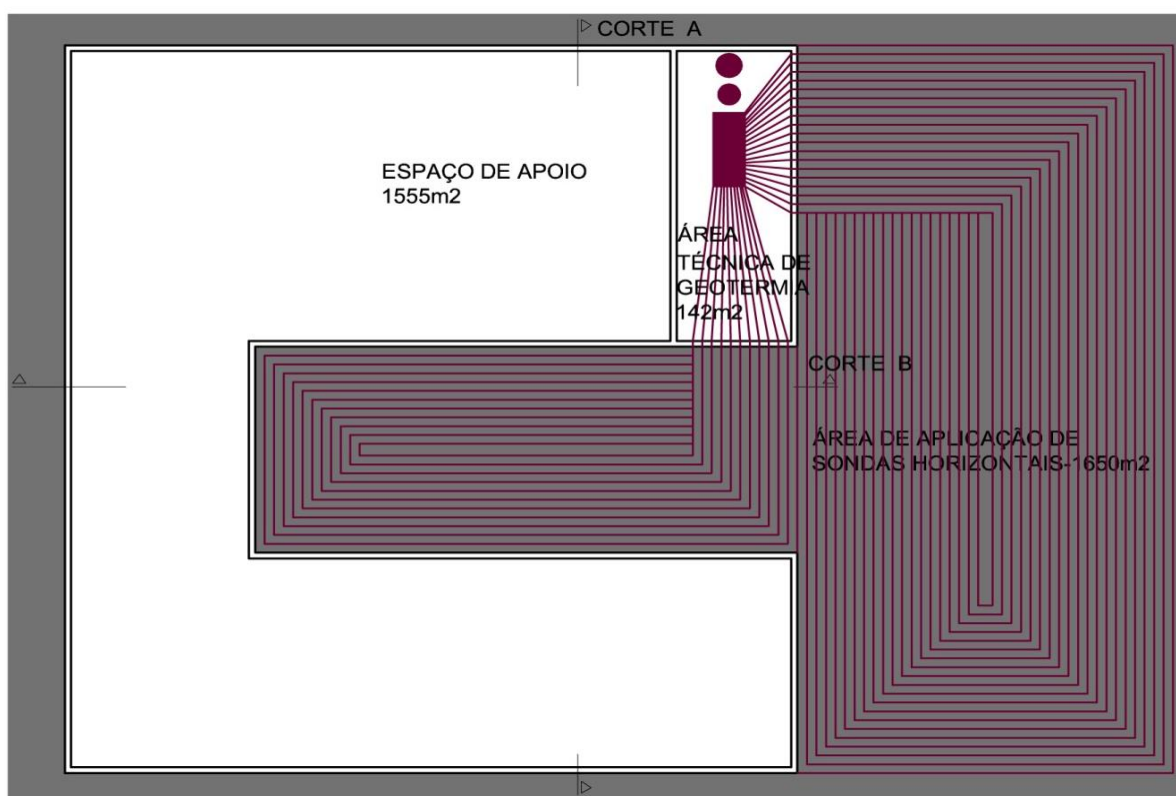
Planta a 1,40 m da superfície do solo (profundidade das sondas horizontais)
